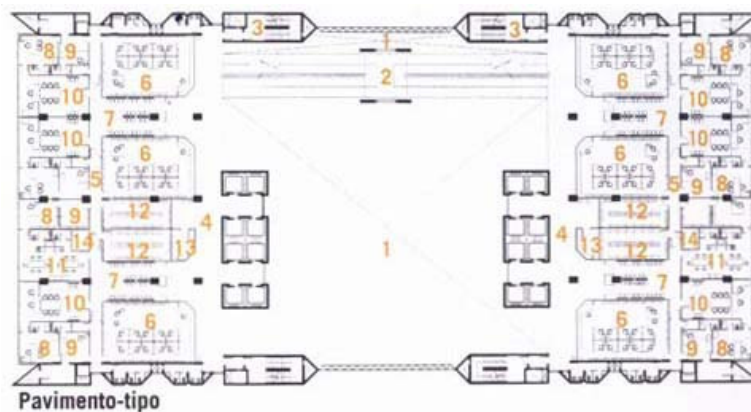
Planta do pavimento-tipo (Fonte: Décio Tozzi Arquitetura)
